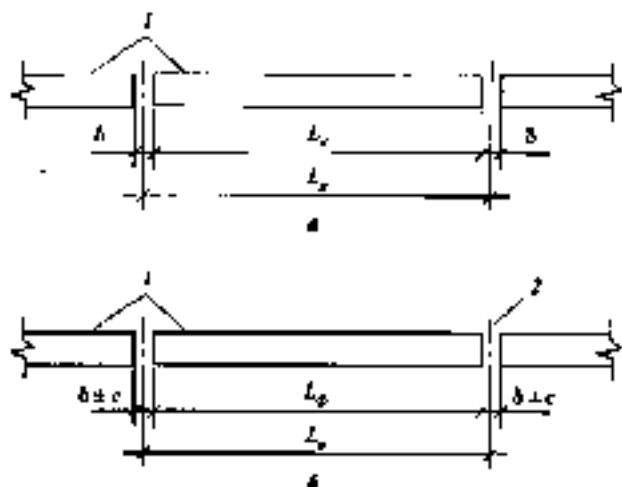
Размеры конструктивных элементов; а- номинальный и конструктивный, б- натурный; 1- конструктивные элементы, 2- зазор
